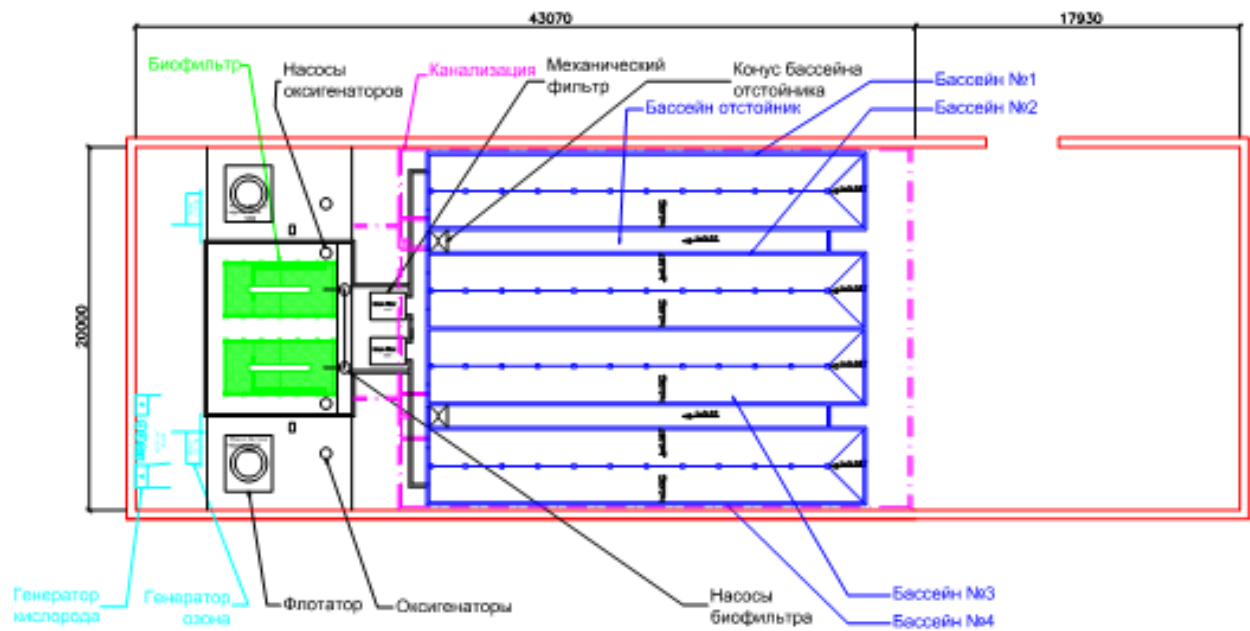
6.14 Схема УЗВ с бетонными прямоугольными бассейнами (вариант 1)
